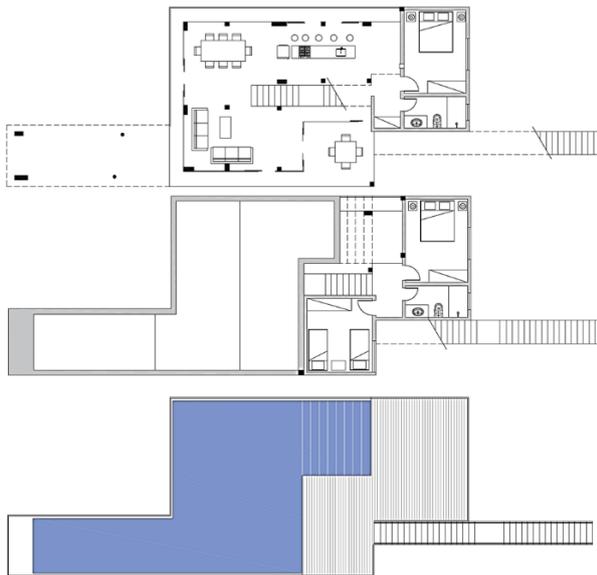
Desenho do térreo, primeiro pavimento e cobertura (respectivamente)
